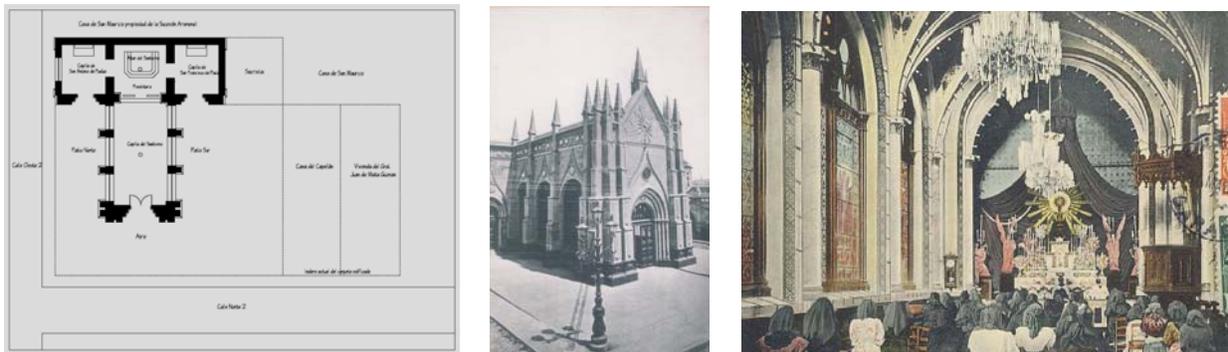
Santa Capilla en 1883. a.- Planta, b.- Imagen exterior 1883, c.- Interior.
